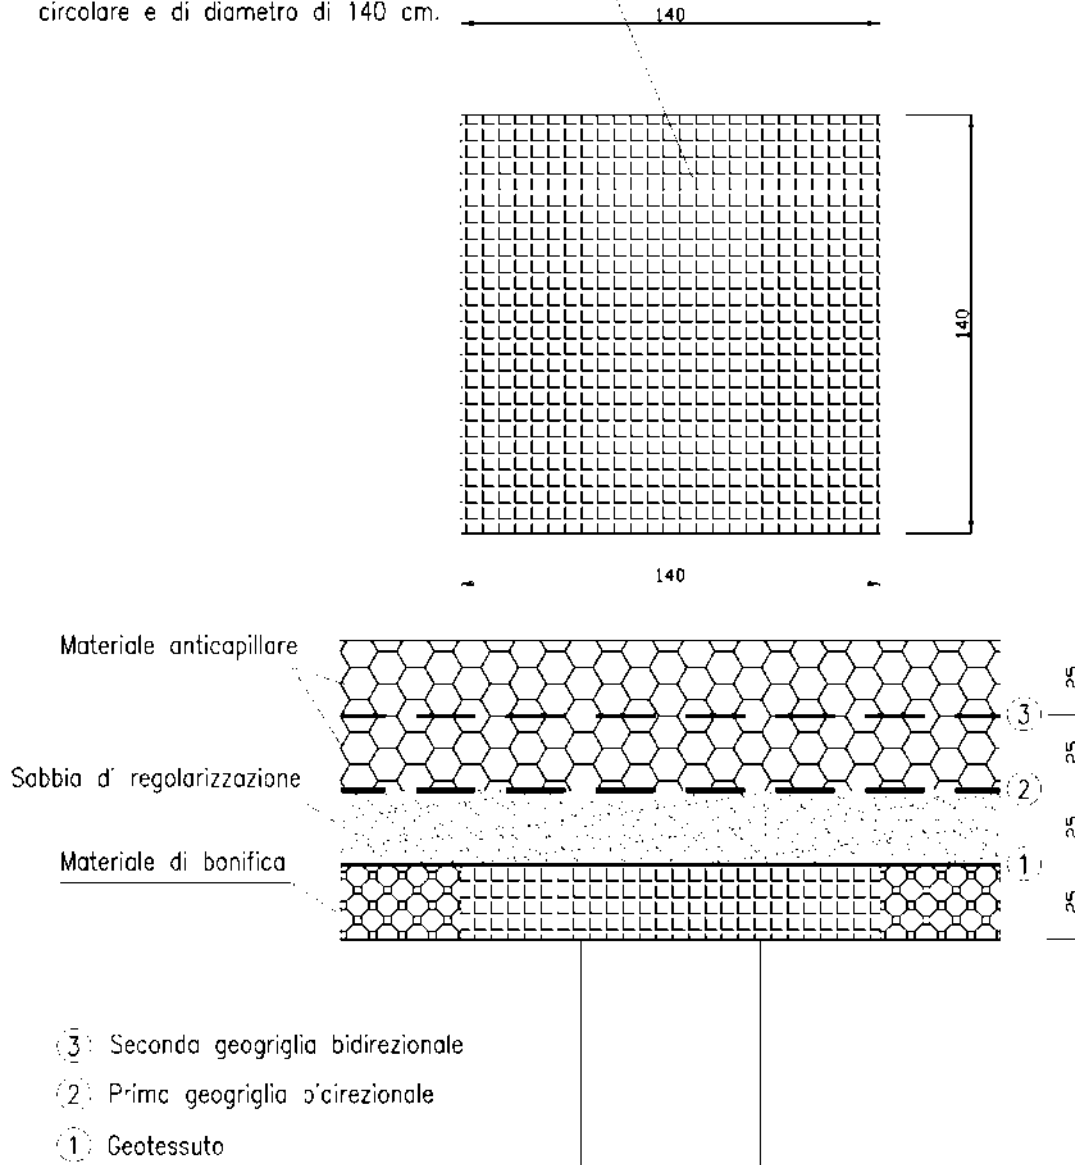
Trattamenti colonnari – particolare B – soluzione 1
